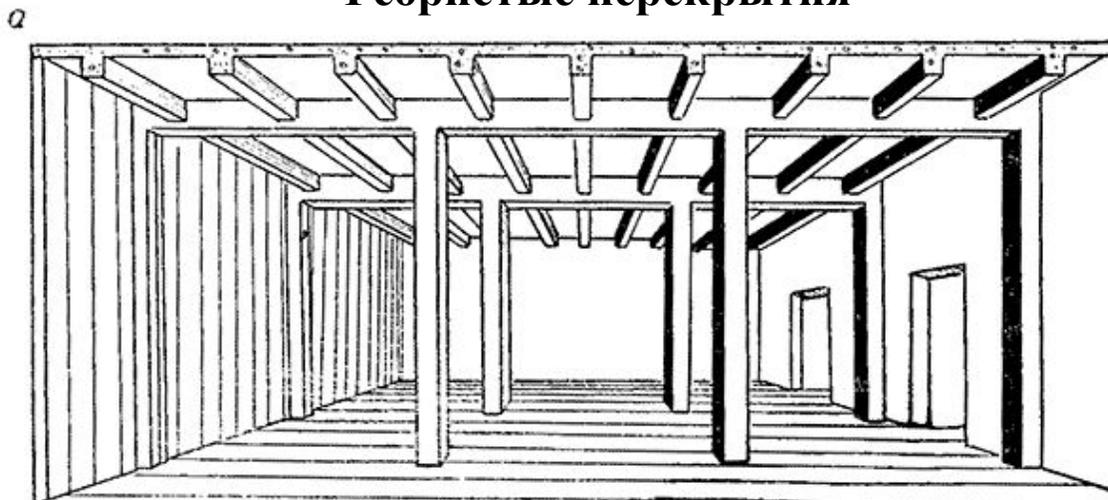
Железобетонное монолитное ребристое покрытие:
